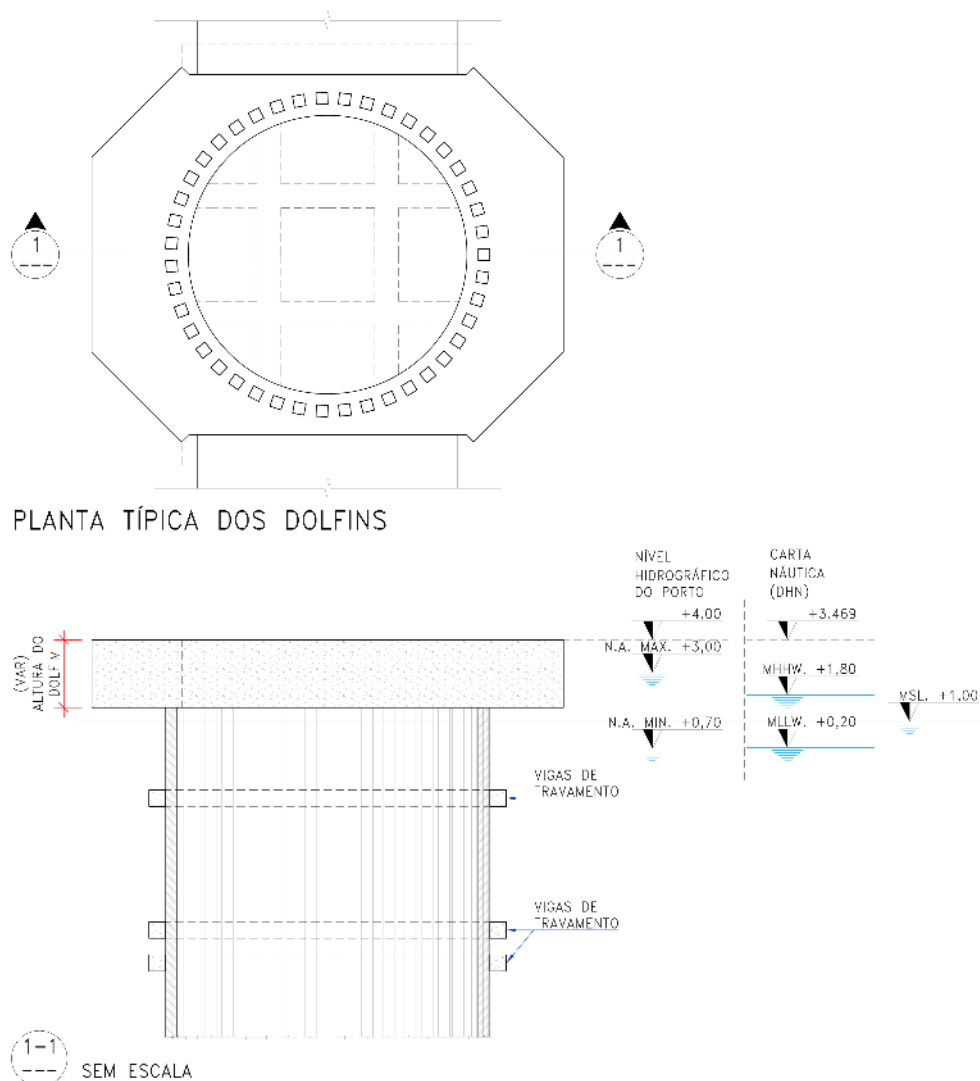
Planta e Seção Típica das Estruturas dos Dolfin
